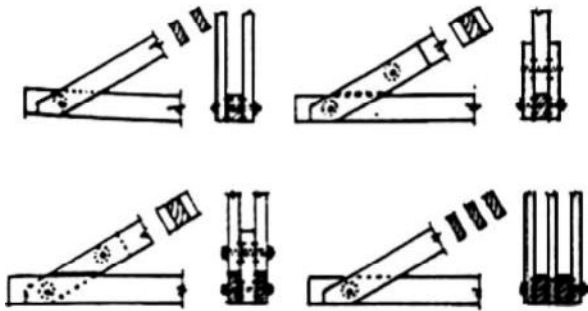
Empleo de tensores en elementos de trabajo a tracción.
